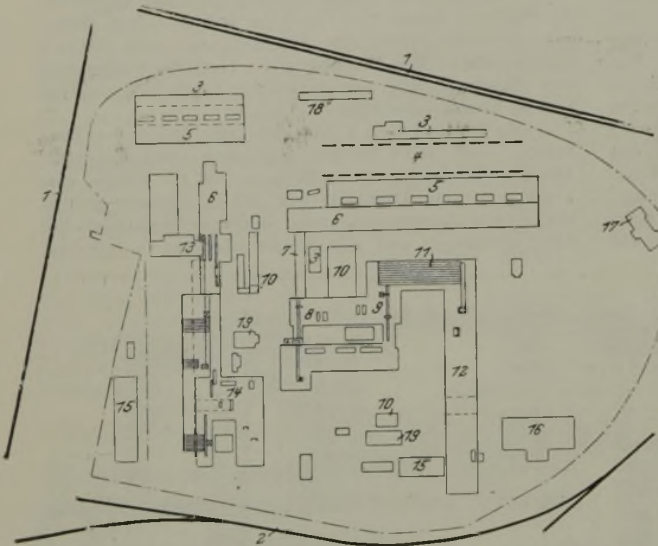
Lageplan der Port-Talbot-Stahlwerke Baldwins Ltd.
